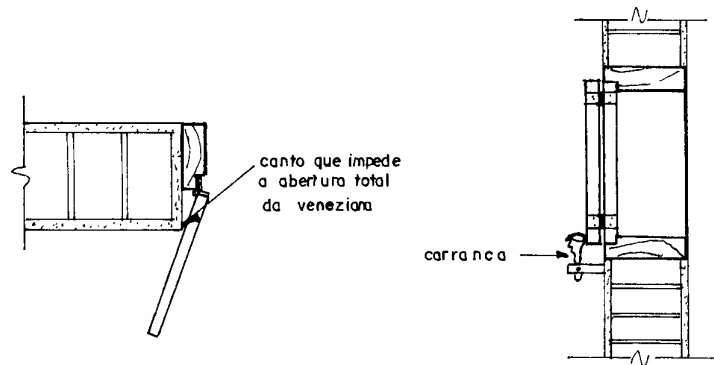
Detalhes da fixação das janelas em alvenaria de um tijolo
